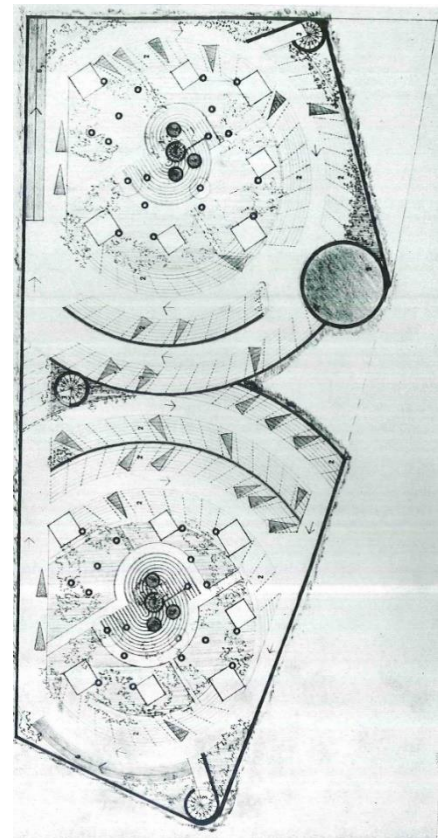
planos originales de planta de aparcamiento del conjunto
